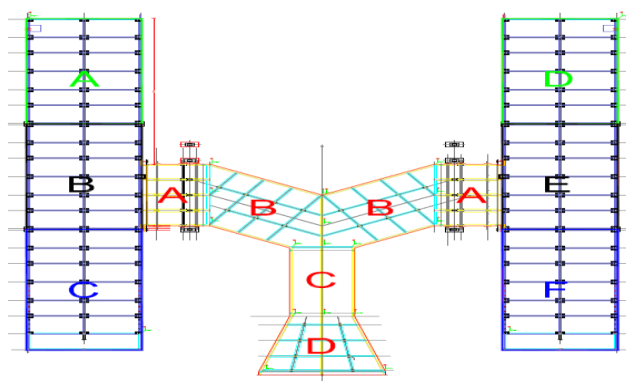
Modelo em 2D para as torres de arrefecimento e Culvert da CCC do Soyo.
